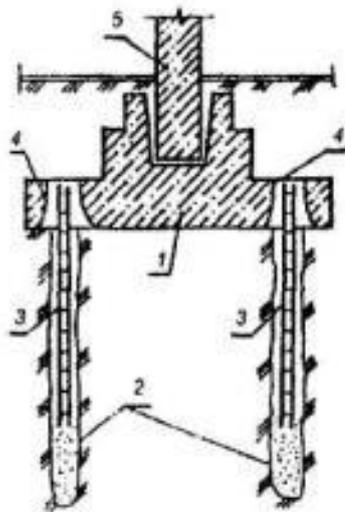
1 - усиливаемый столбчатый фундамент; 2 - буроинъекционные (корневидные) сваи диаметром 100-250 мм, устраиваемые через плитную часть усиливаемого фундамента; 3 - арматурные каркасы; 4 - конусные отверстия в плитной части фундамента; 5 - железобетонная колонна.
